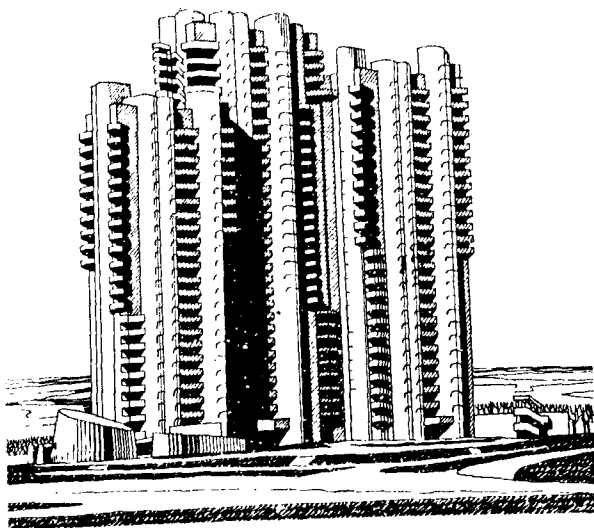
Архитектура 25-этажного здания из монолитного бетона (проект)
